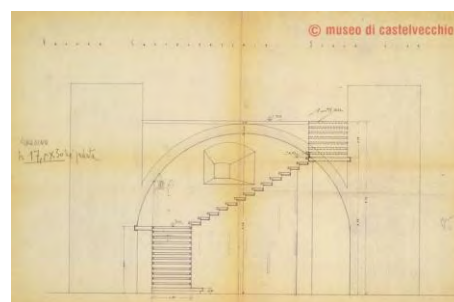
Prospetto della scala tra il piano terra e il primo piano del Mastio.
